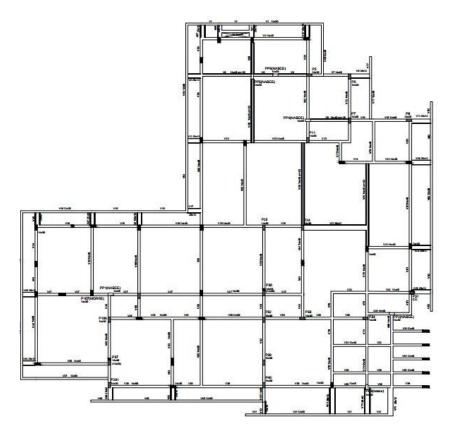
Fôrmas do Pavimento Cobertura Fonte: Projeto Estrutural (2017)
